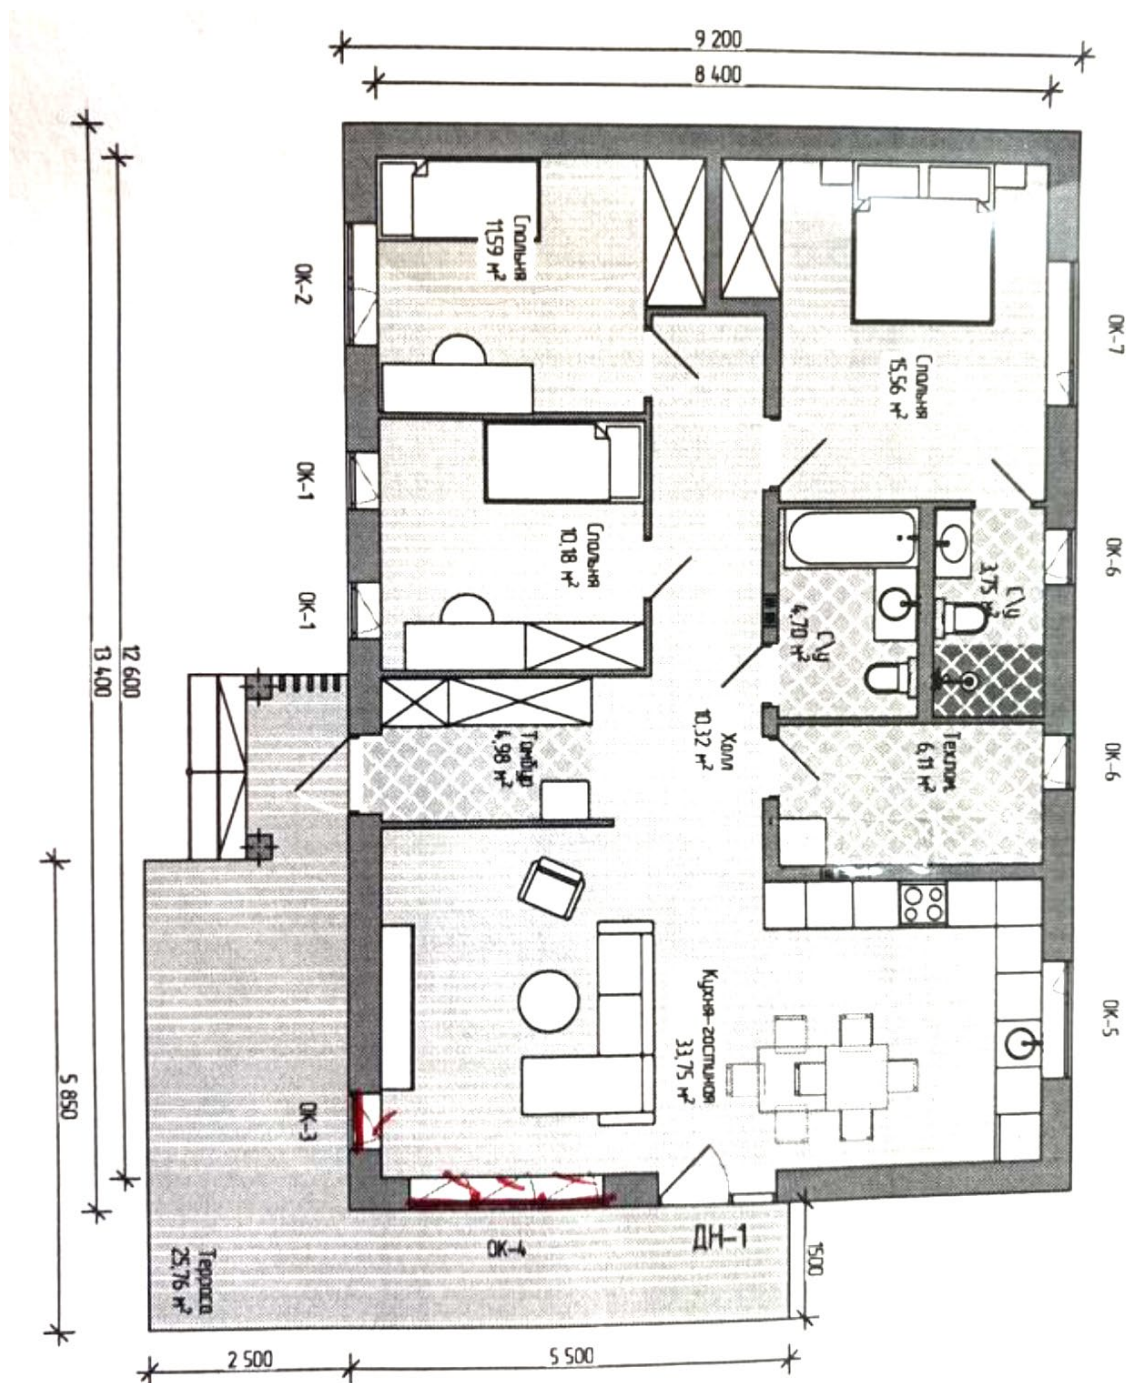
Габаритний план будівлі з газоблоку. Варіант 2.
